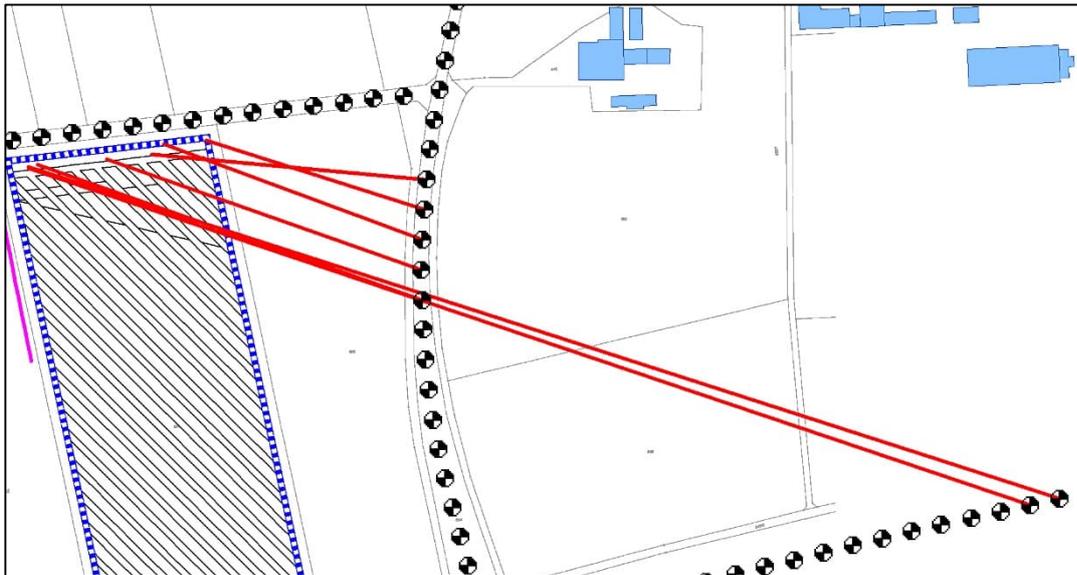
Lageplan mit Darstellung der relevanten, von Blendungen betroffenen Immissionsorte und des jeweils ungünstigsten Blendstrahls
